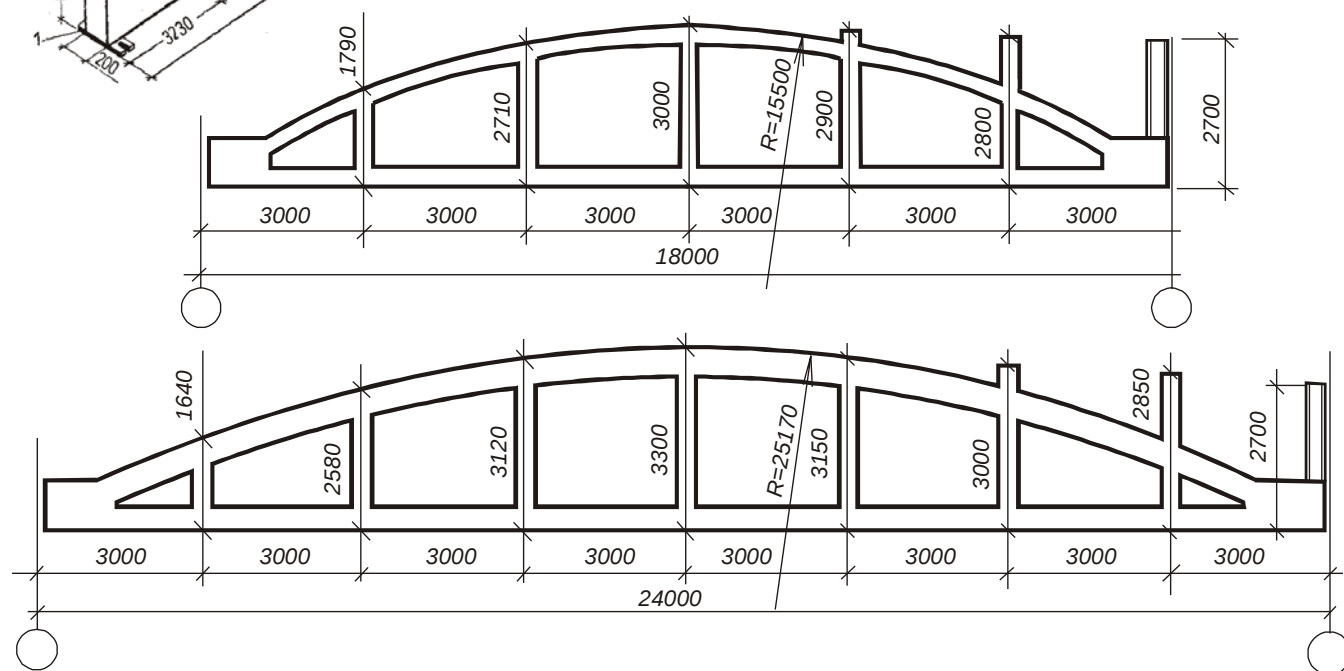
Схемы безраскосных ферм пролетом 18 и 24 м.
